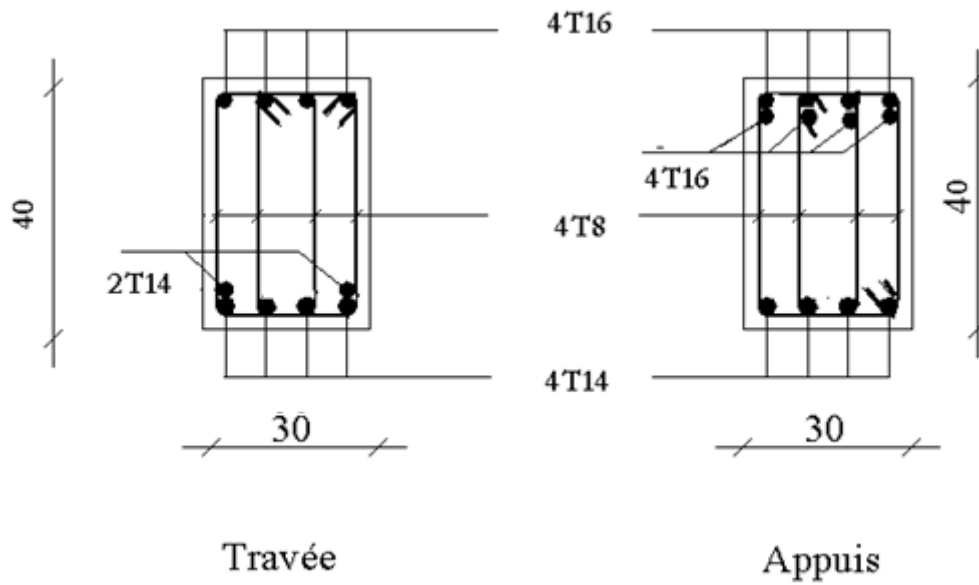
ferrailage des poutres porteuses (30x40).
